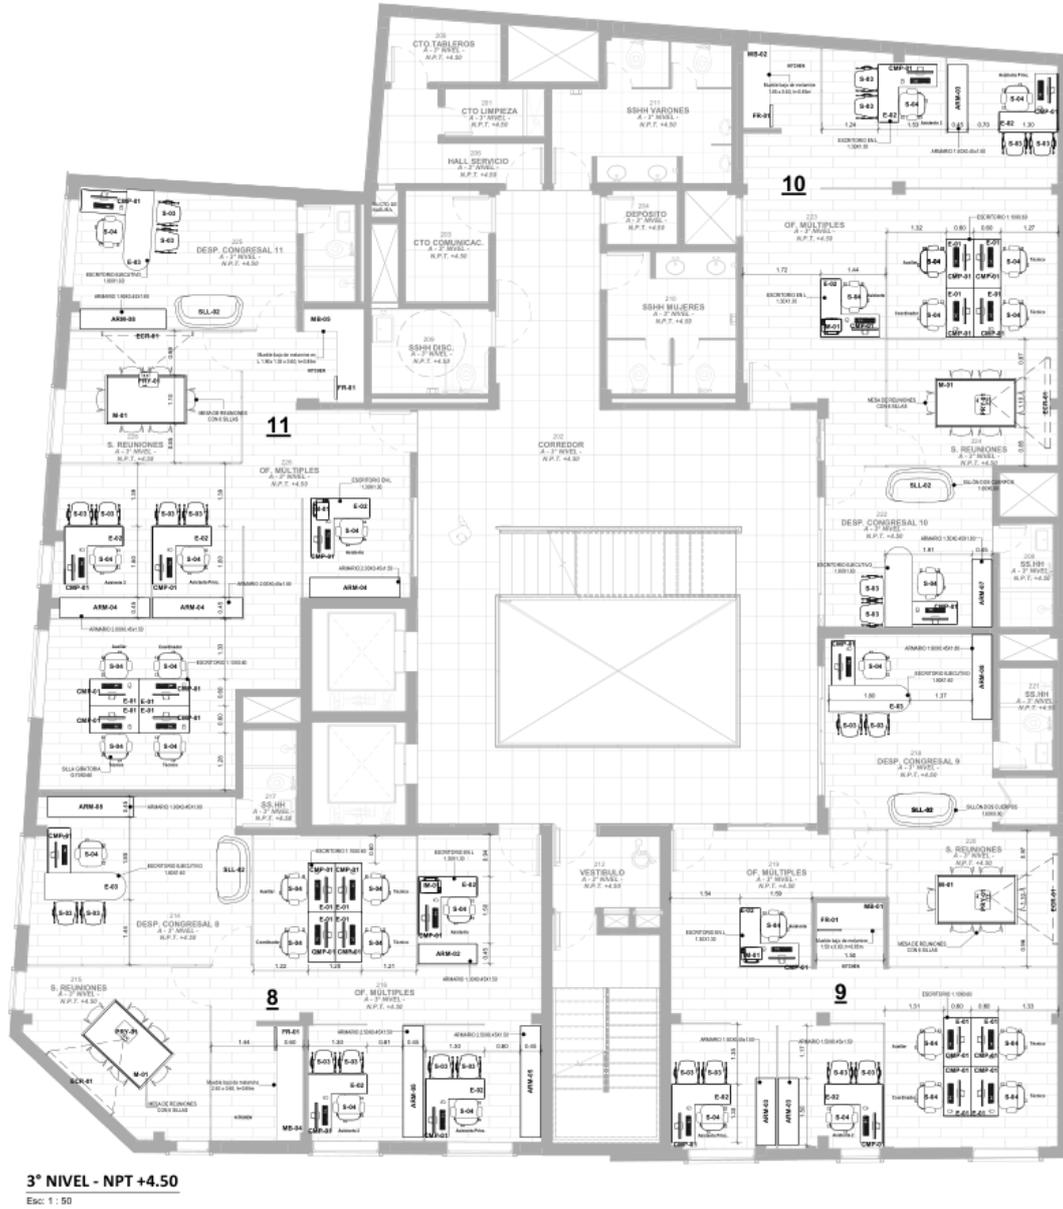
Plano del 3er nivel Activo 2. Fuente: Congreso
